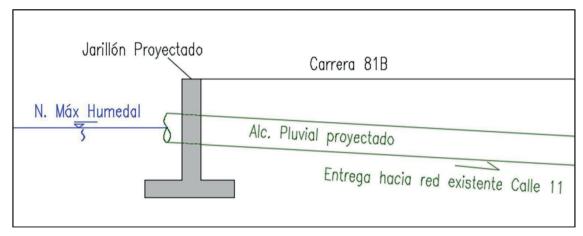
Esquema del jarillón y tubería de rebose que entregaría a las redes proyectadas de Alcantarillado Pluvial que posteriormente entregaría a redes existentes a la altura de la calle 11 con Cra. 81B.
